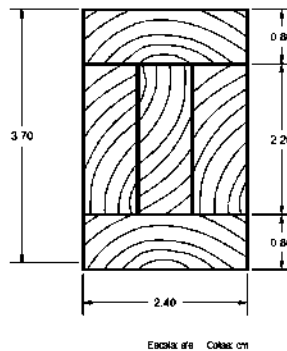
Sección transversal de la viga propuesta a escala 1:4. Imagen propia.
